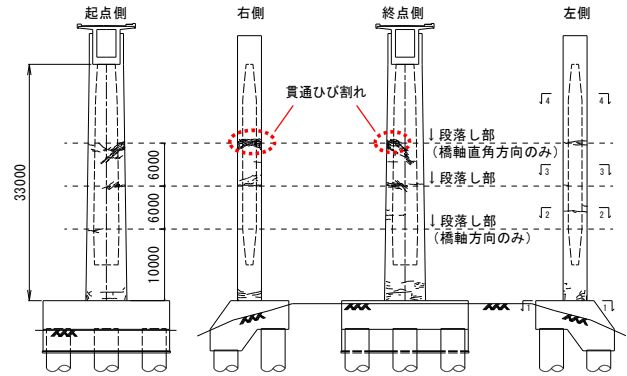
P3橋脚の貫通ひび割れ発生状況
